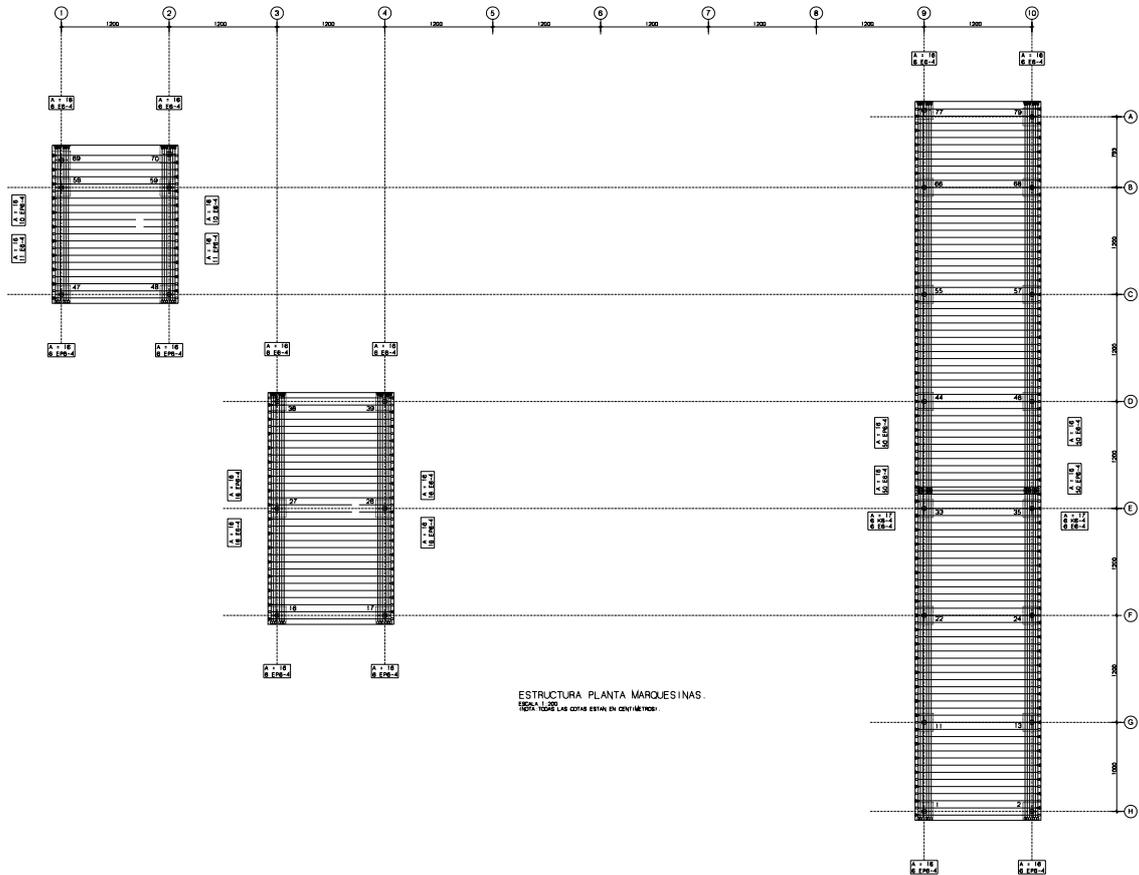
Distribución en planta de los tendones de pretensado en cubierta.
